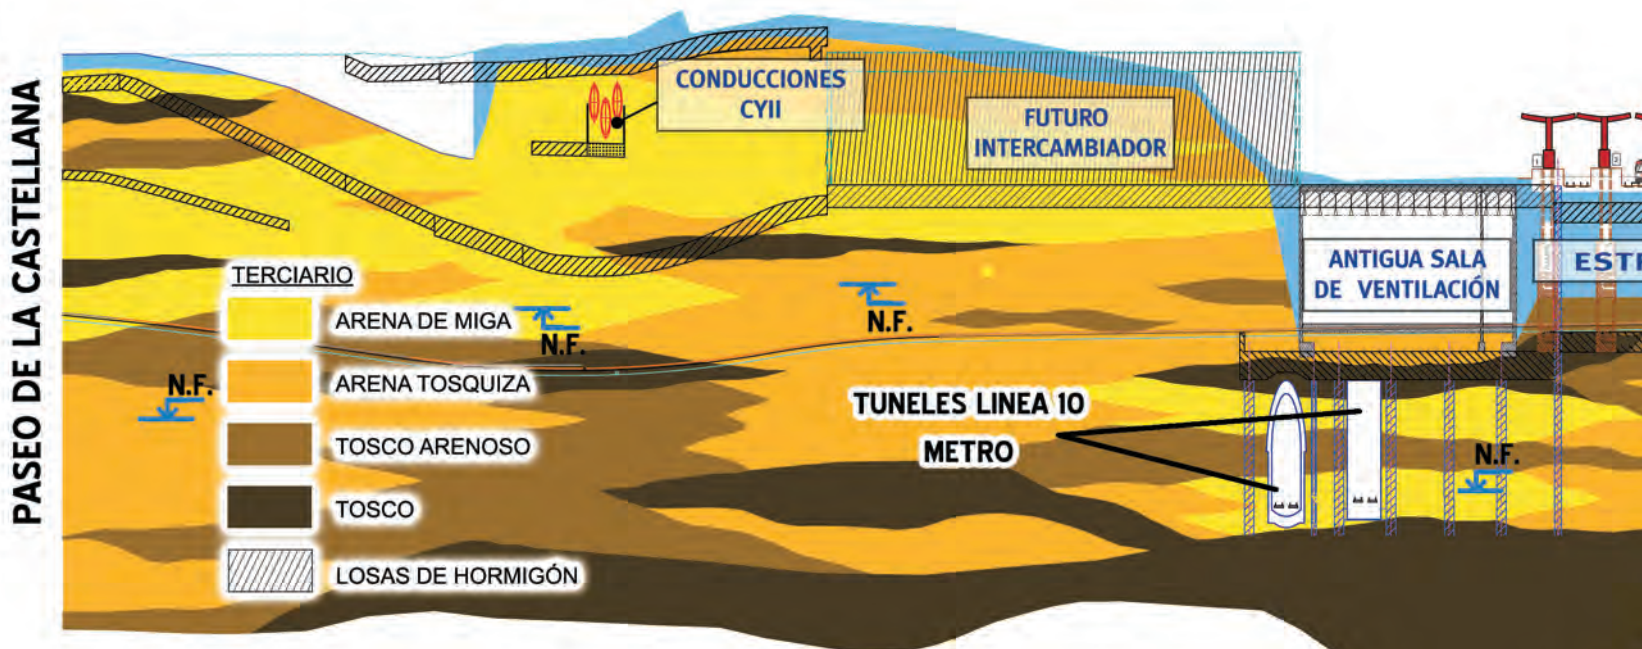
Perfil longitudinal geotécnico/Geotechnical longitudinal profile.
